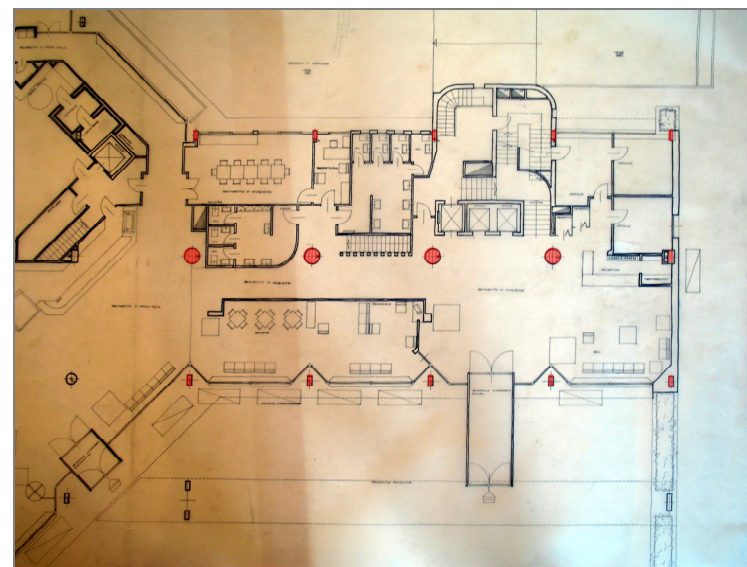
disposizione pilastri corpo A (fonte CSAC – stralcio tav. 38, archivio n. 161-1, rielaborazione f.m.)
